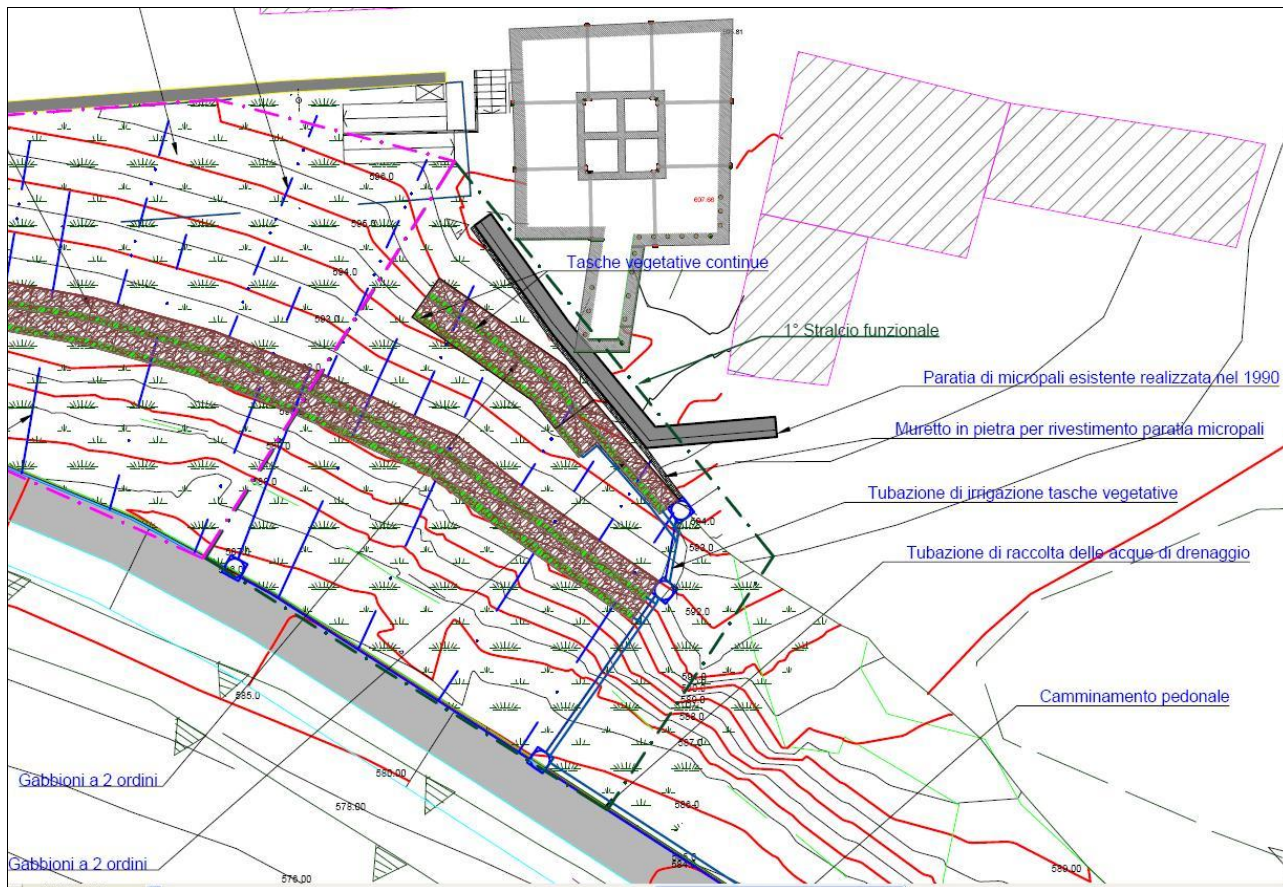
Estratto dalla Tav. N. 08 – PG “Planimetria generale: Stato di Progetto” – Progetto preliminare – luglio 2013
